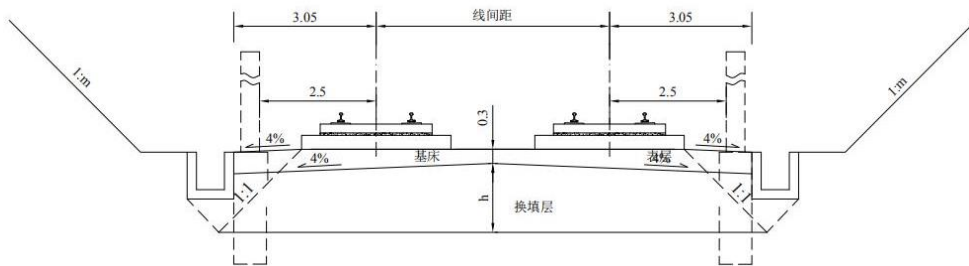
无砟轨道双线非硬质岩路堑横断面图一 (单位: m)
